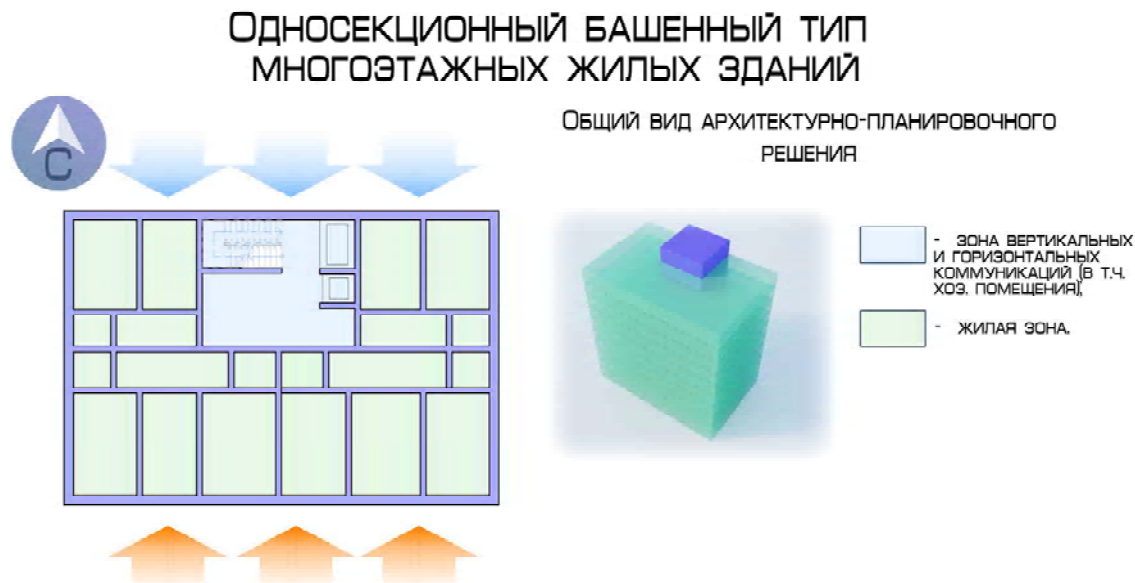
Схема плана односекционного башенного типа многоэтажных жилых зданий. Общий вид архитектурно-планировочного решения.
